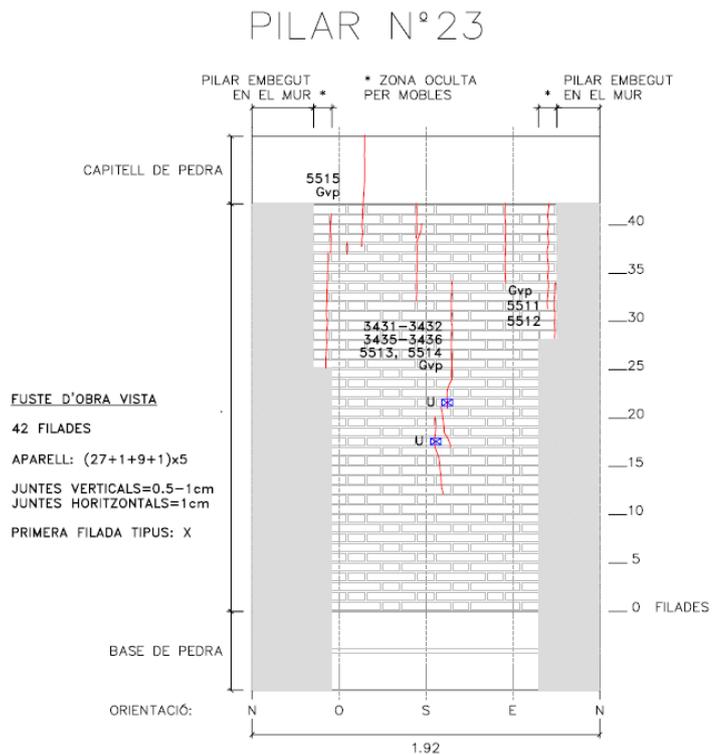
Desarrollo del pilar 23 y su fisuración.
